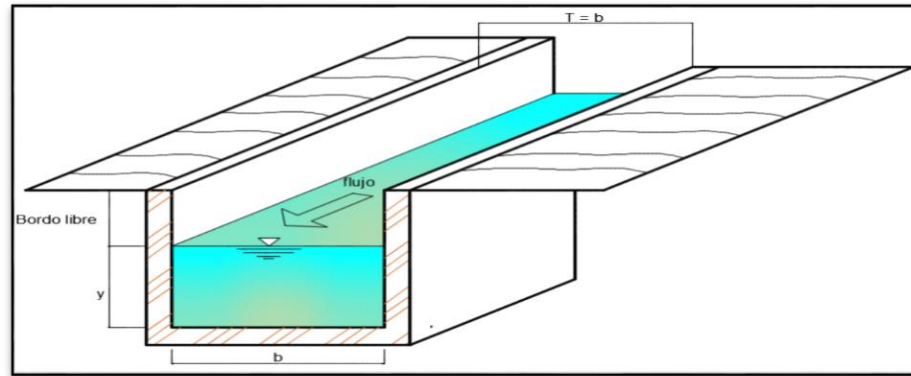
Sección transversal y longitudinal de un canal rectangular⁵.
